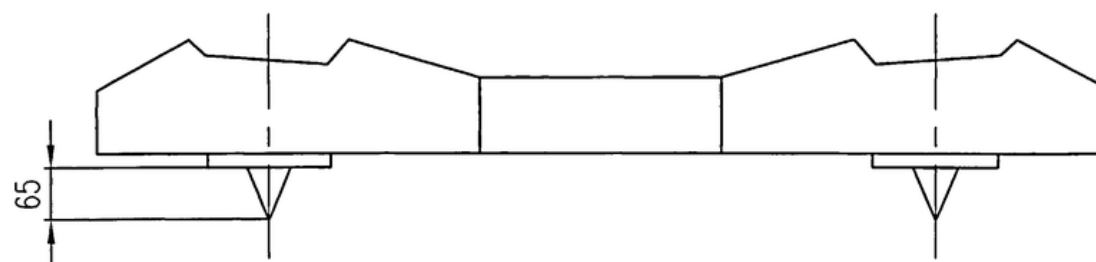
Конструкція рейкової опори із зубатими виступами
